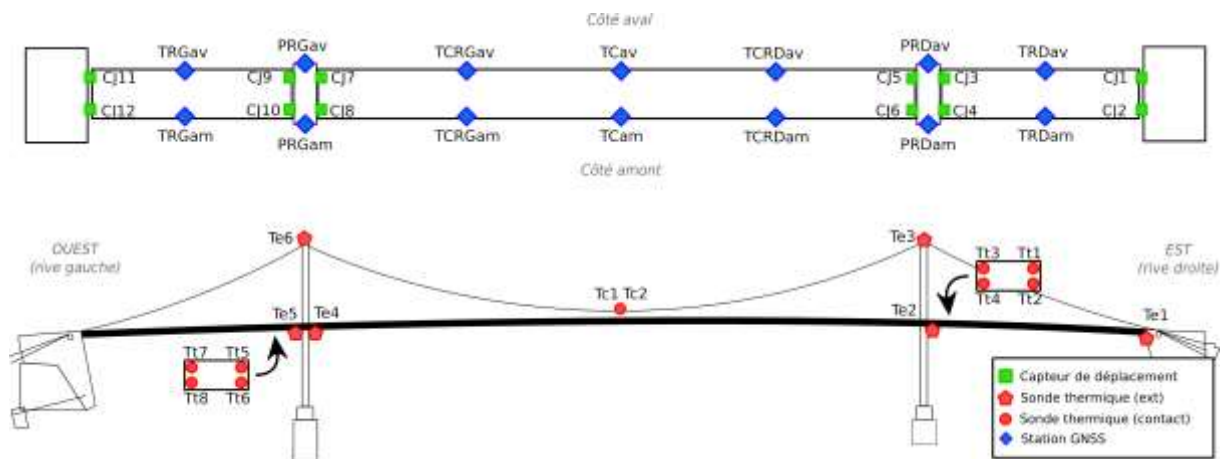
Plan d'installation des capteurs sur le pont d'Aquitaine
